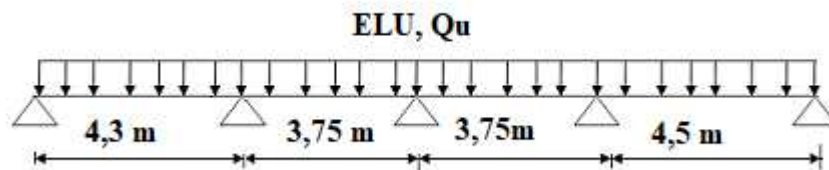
Schéma statique de la poutrelle à 4 travées
